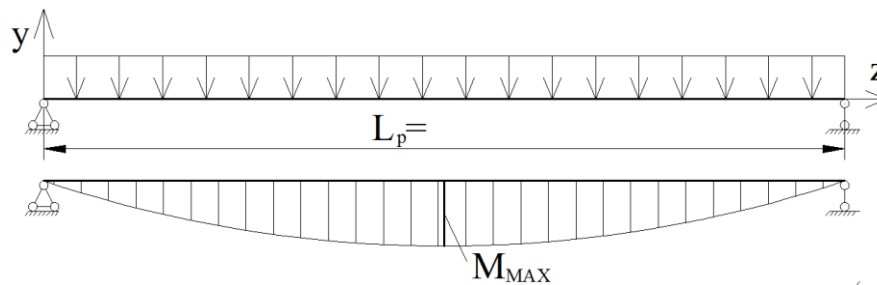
Расчетная схема балки и эпюра моментов от заданной нагрузки
